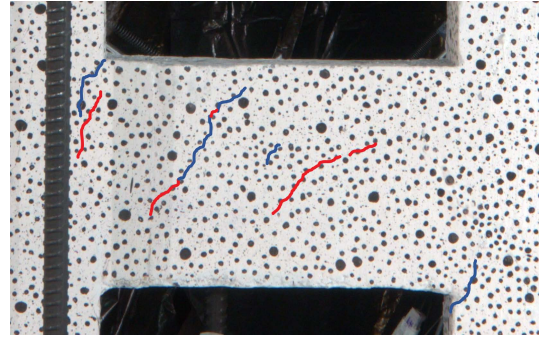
Grietas Vigas a -0.4% Drift
